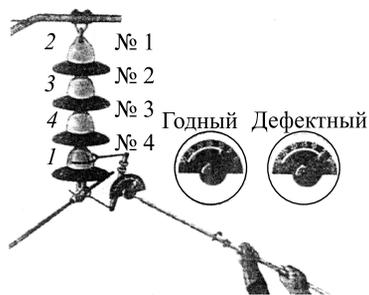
Штанга ШИ-35/100 кВ для дефектировки изоляторов контактной сети переменного тока: № 1—4 — номера изоляторов; 1—4 — последовательность проверки изоляторов
